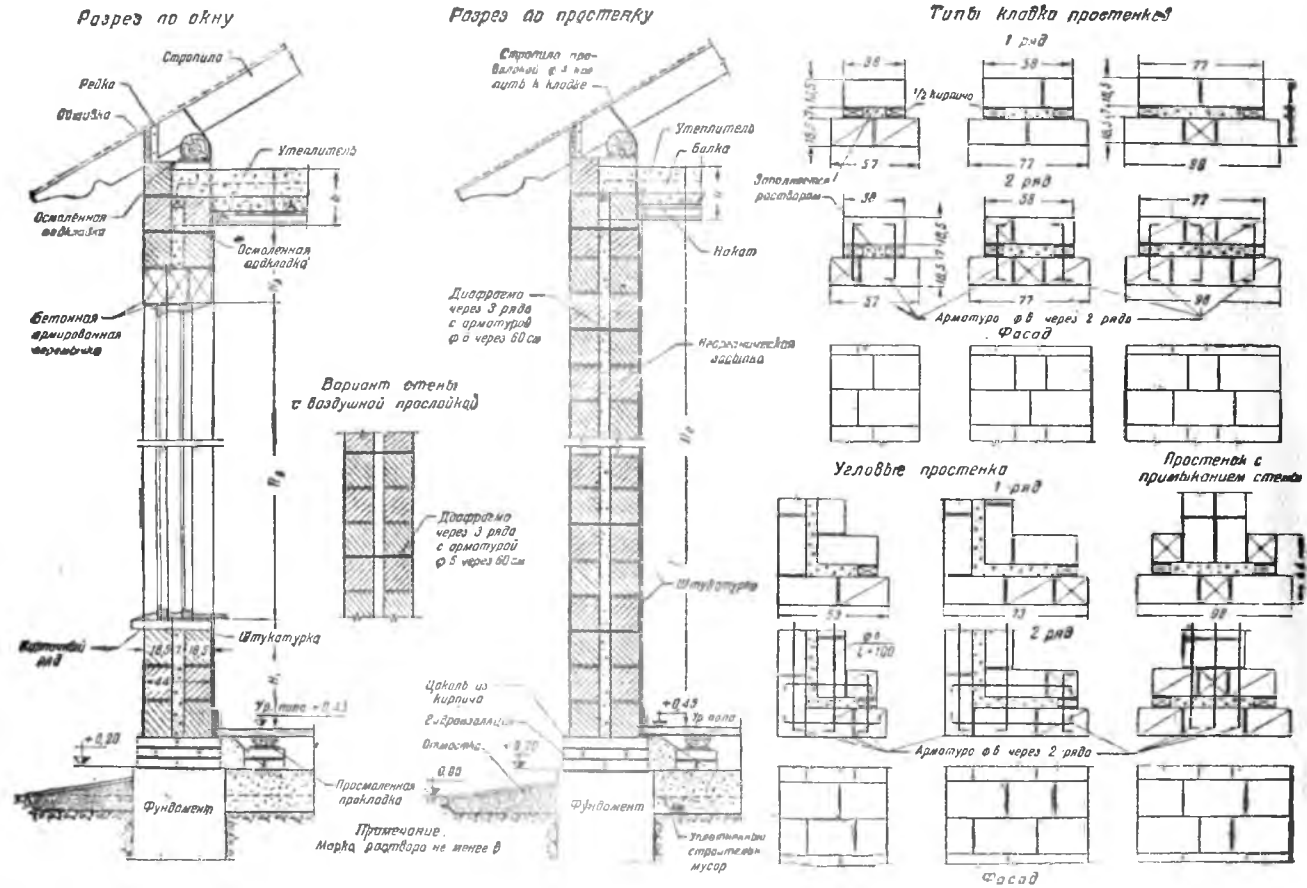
Засыпные стены из полномерных блоков. Пустотные стены из полномерных блоков. Разрезы по одноэтажной стене, кладка простенков и углов
